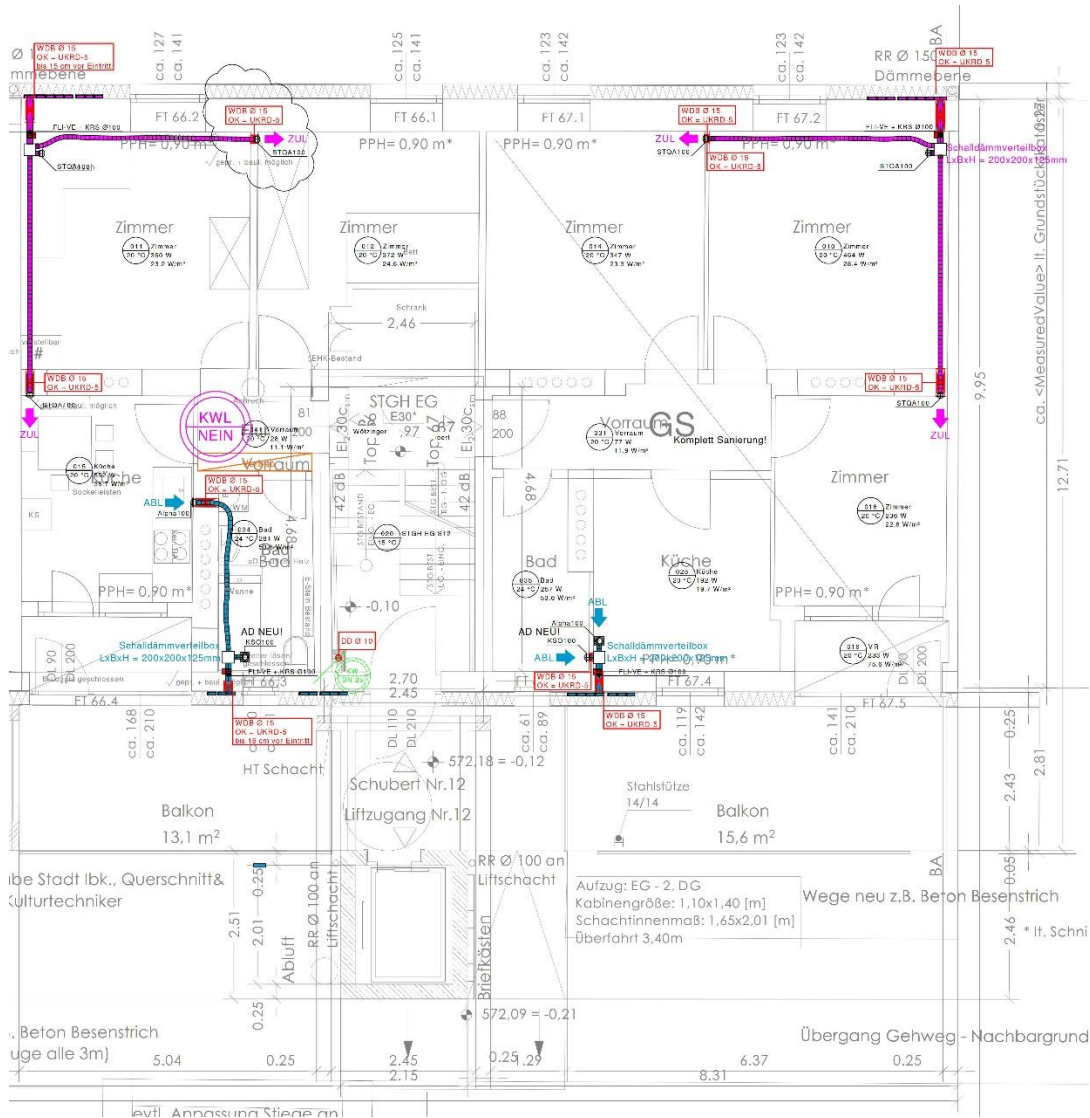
Grundriss Erdgeschoss; Quelle: Alpsolar Klimadesign
